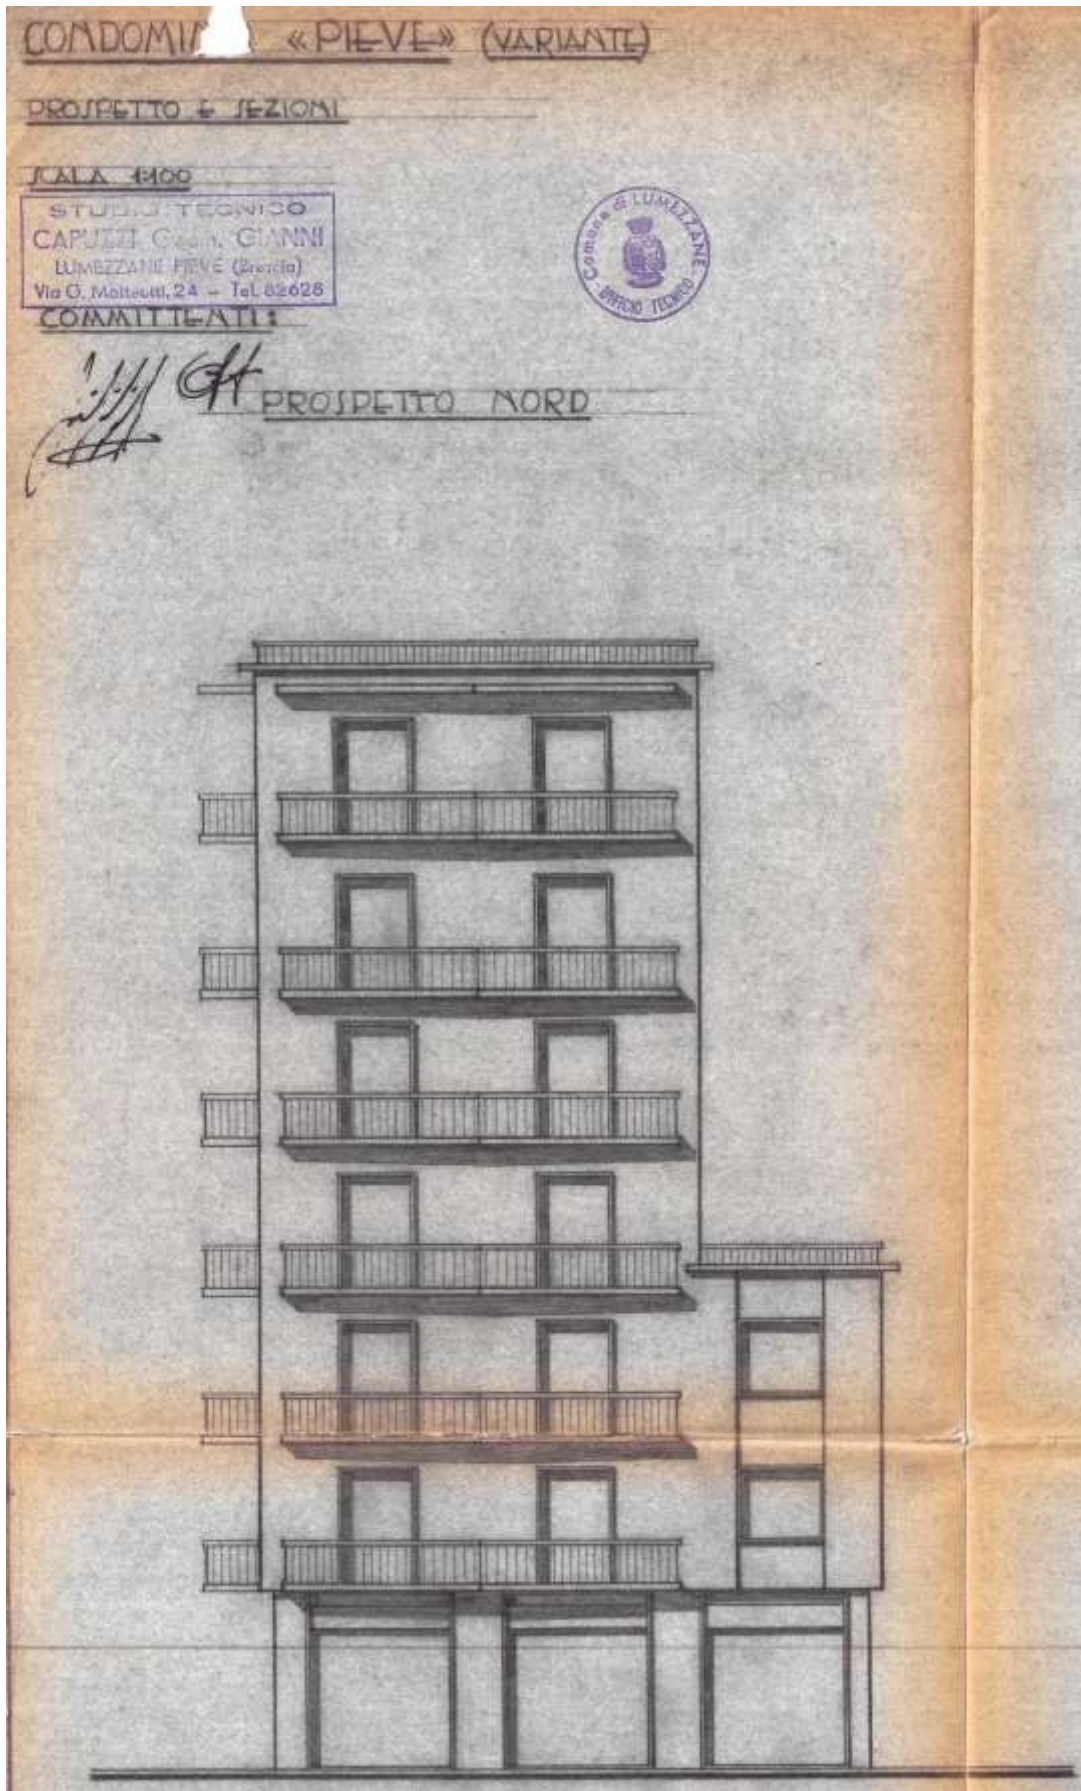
Licenza Edilizia n°461/6 del 17/10/1963, stralcio tavola di progetto (VARIANTE)
